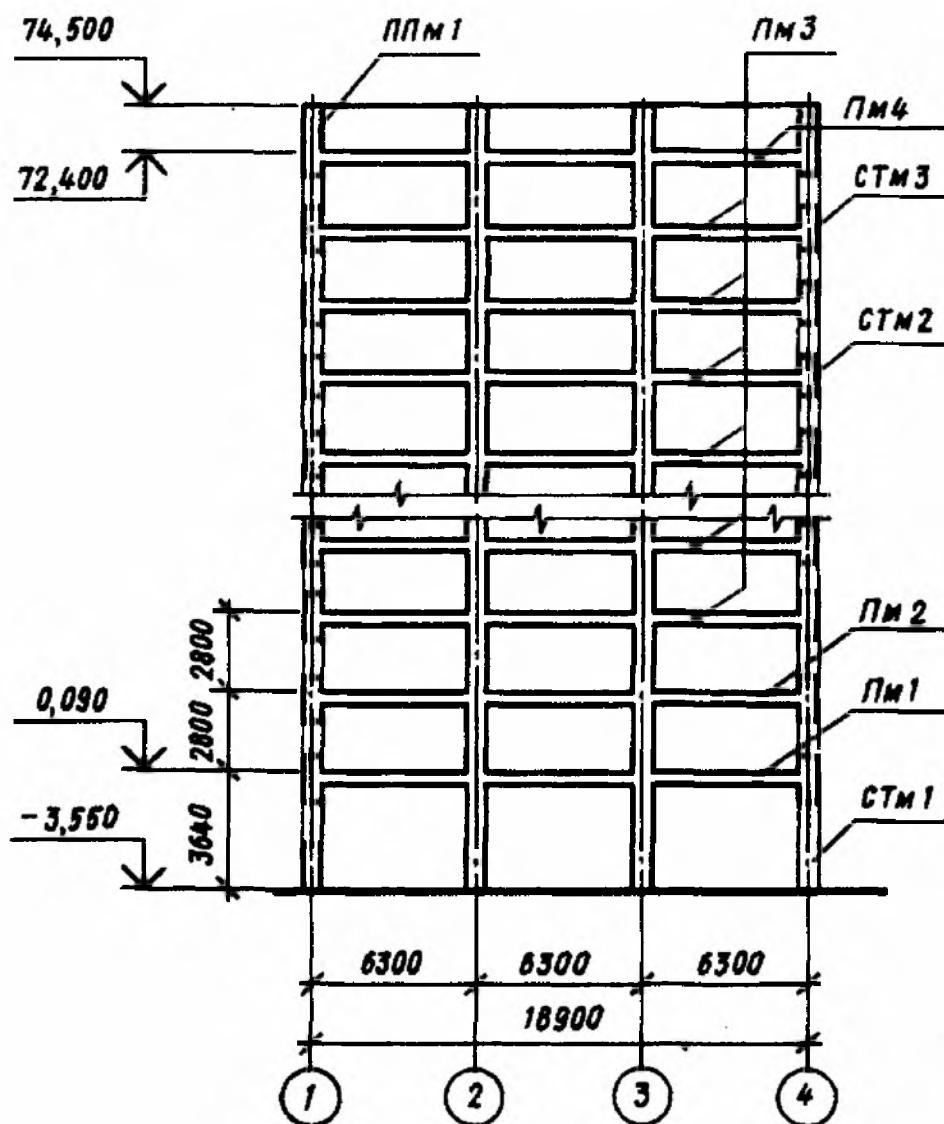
Схема расположения (разрез) монолитной железобетонной конструкции здания
